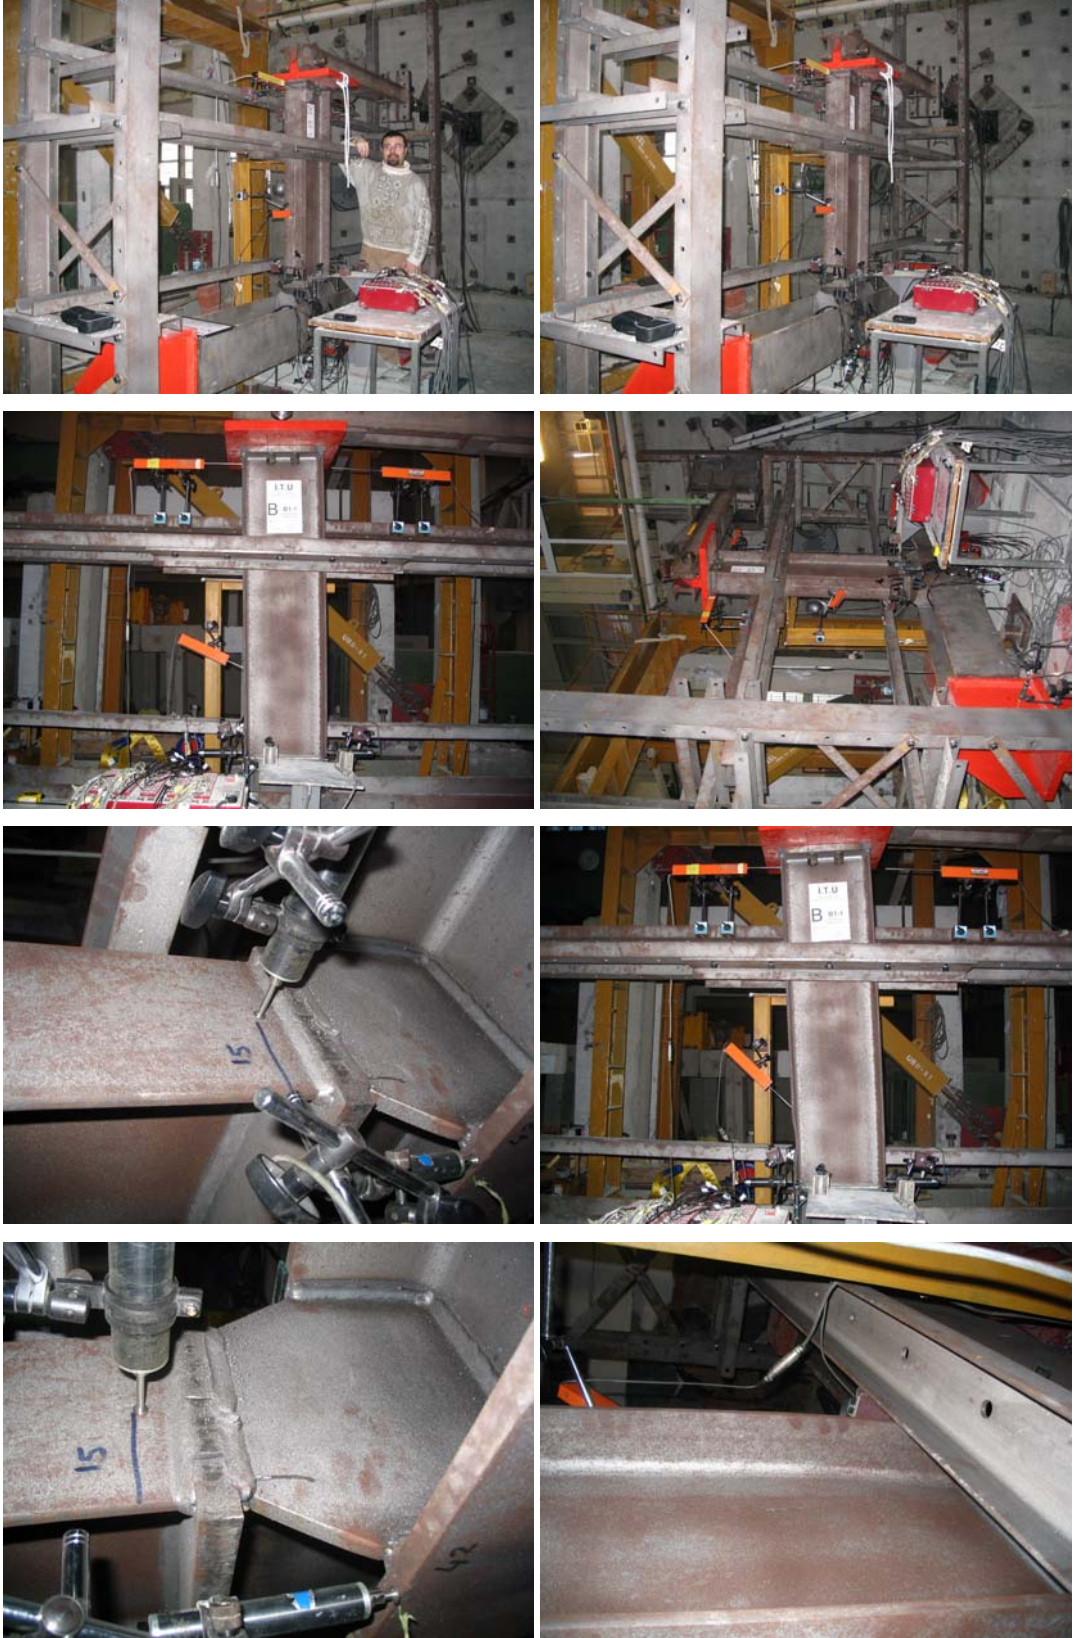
A3-1 grubu deney fotoğrafları.
